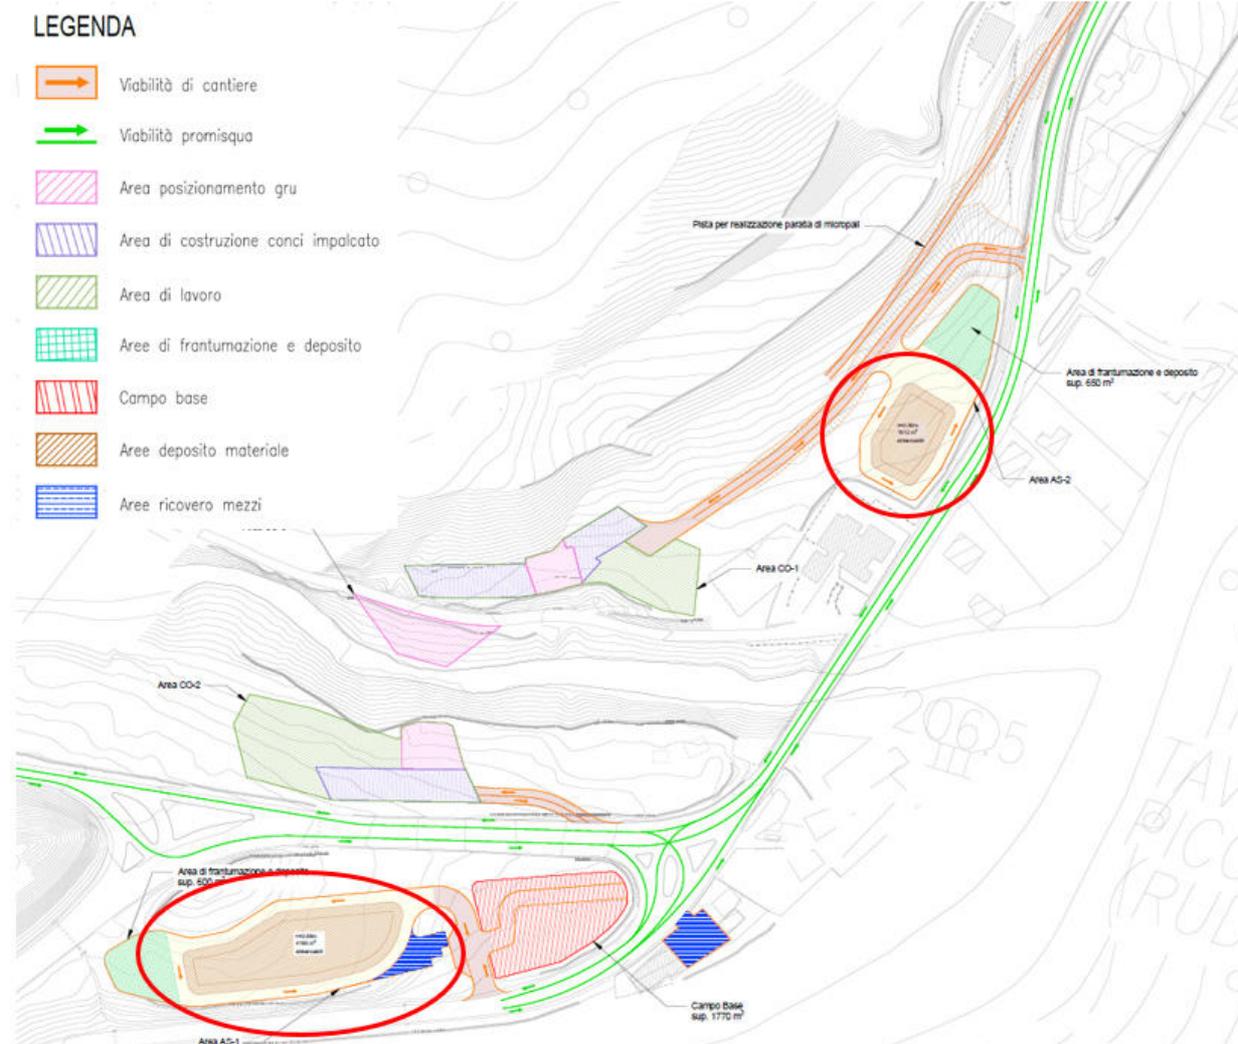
Stralcio planimetrico localizzazione aree di deposito e viabilità di servizio
